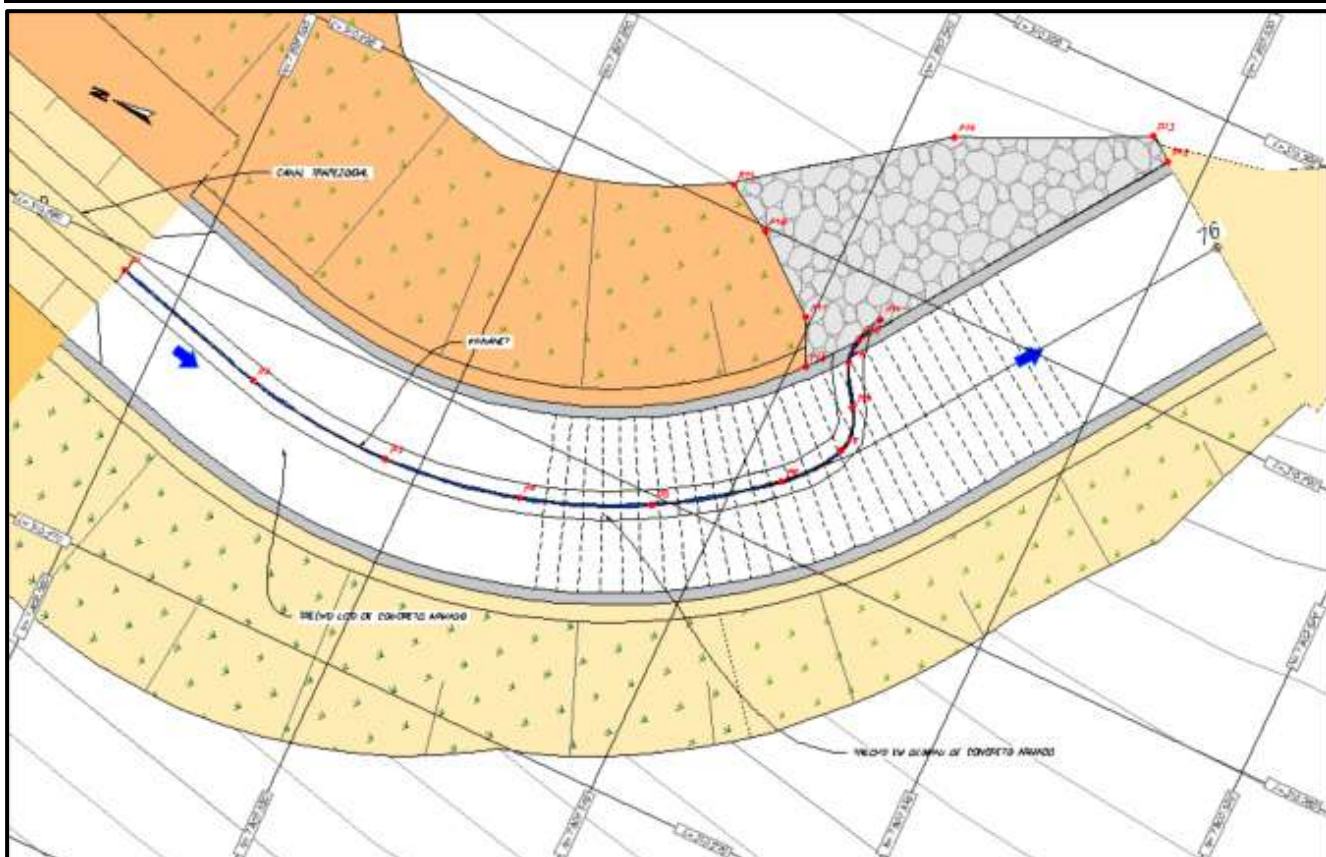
Planta da drenagem sob o canal em concreto.
